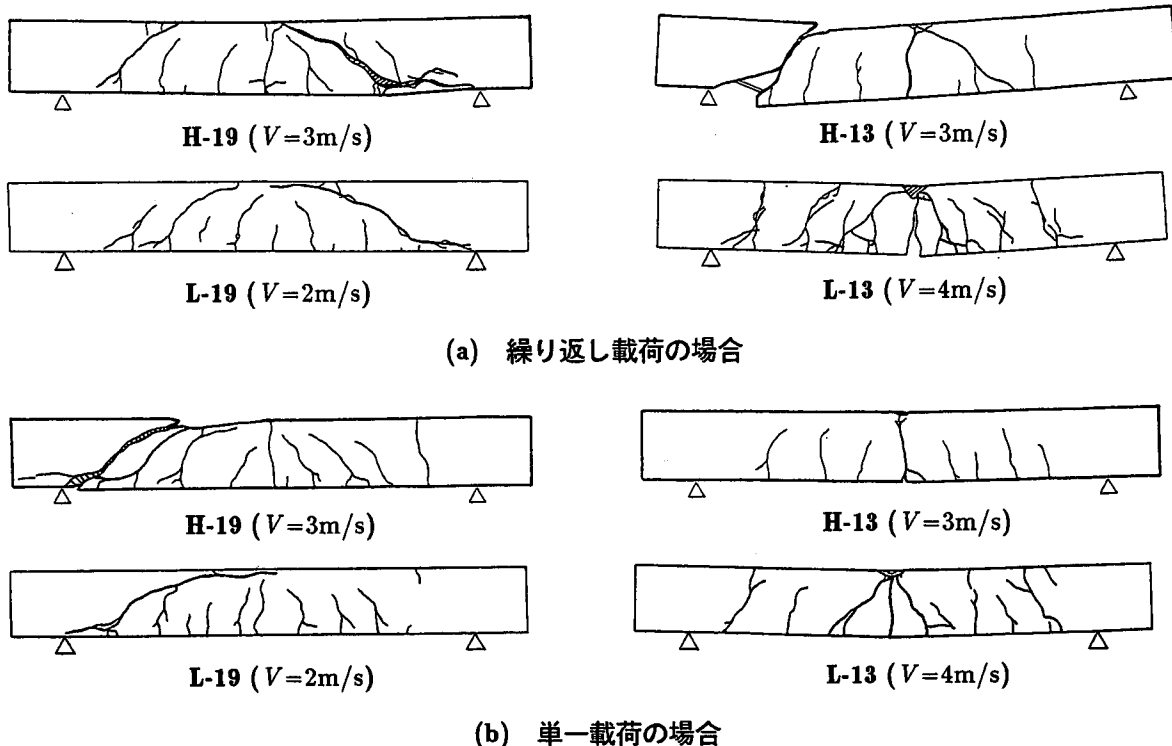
各 RC 梁の実験終了後のひび割れ状況
